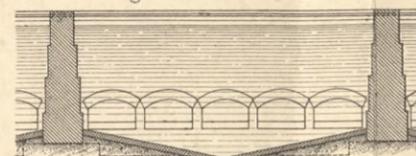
<sup>b</sup> Schnitt A-B. M.1:150.
